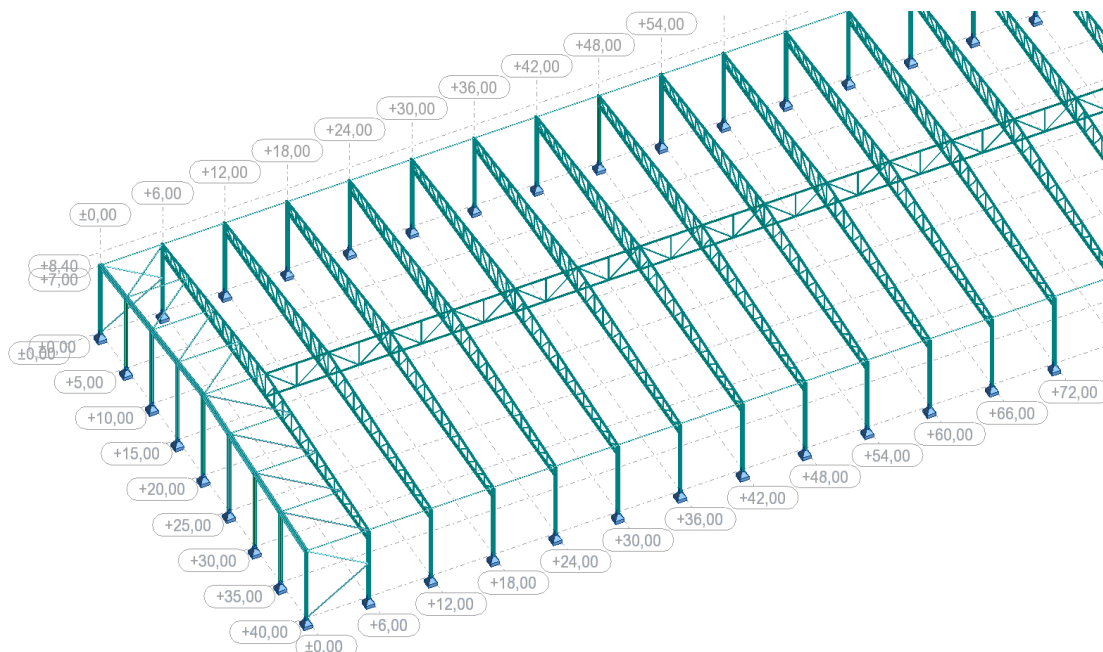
Exemplo do contraventamento aplicado - vista 3D (caso de estudo T40-6)
